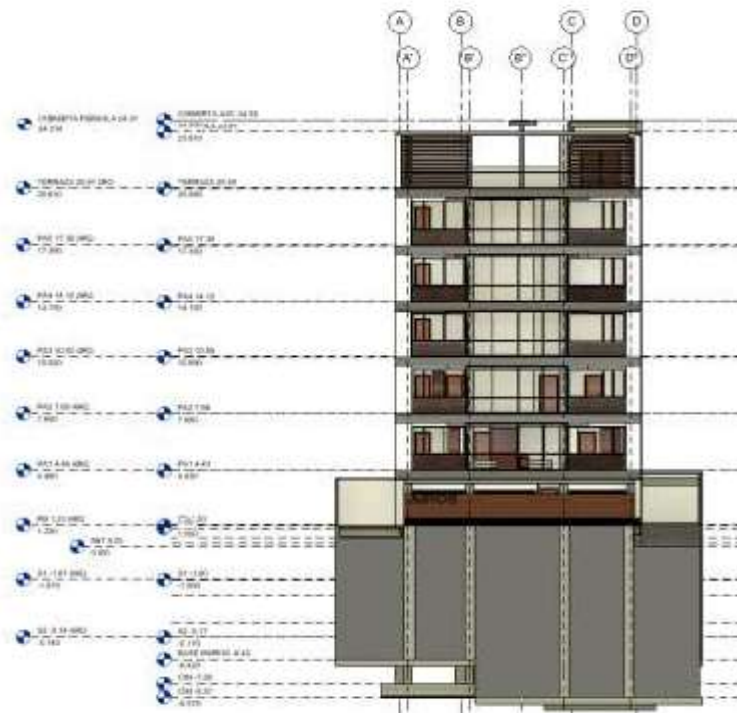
Plantilla niveles de entresijos del modelo arquitectónico.
